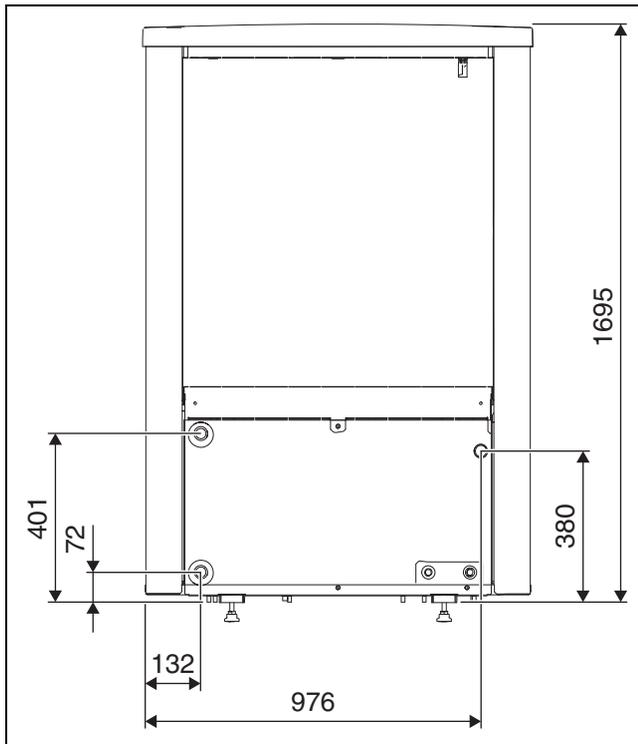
Dimensions et raccordements des modèles de pompe à chaleur 13-17, partie arrière
